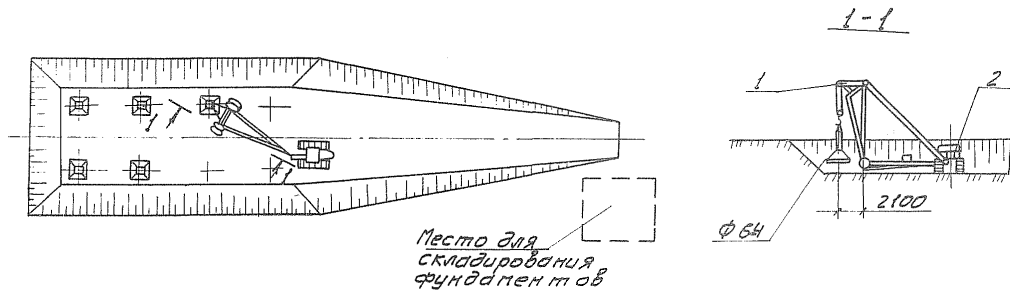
Схема установки ж.б. фундаментов в грунтах I группы
